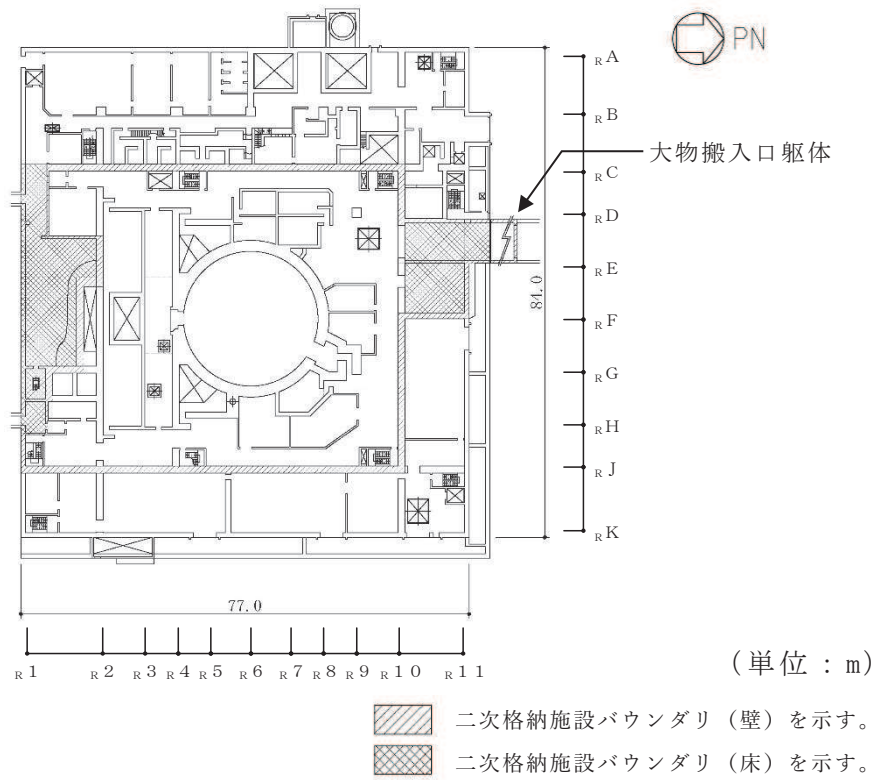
原子炉建屋原子炉棟（二次格納施設）の範囲の平面図
